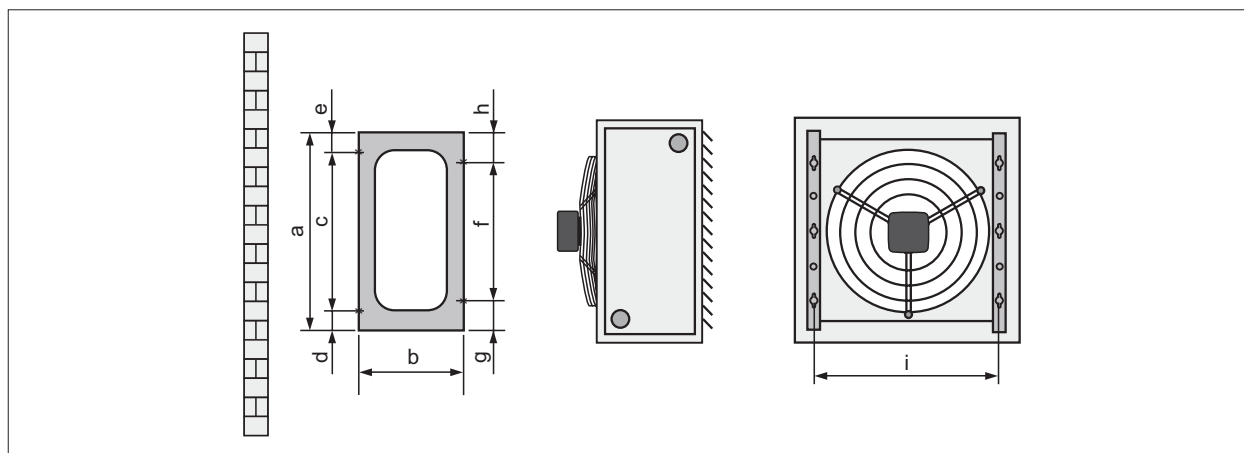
Монтаж воздухонагревателя на стене с помощью крепежных кронштейнов.
